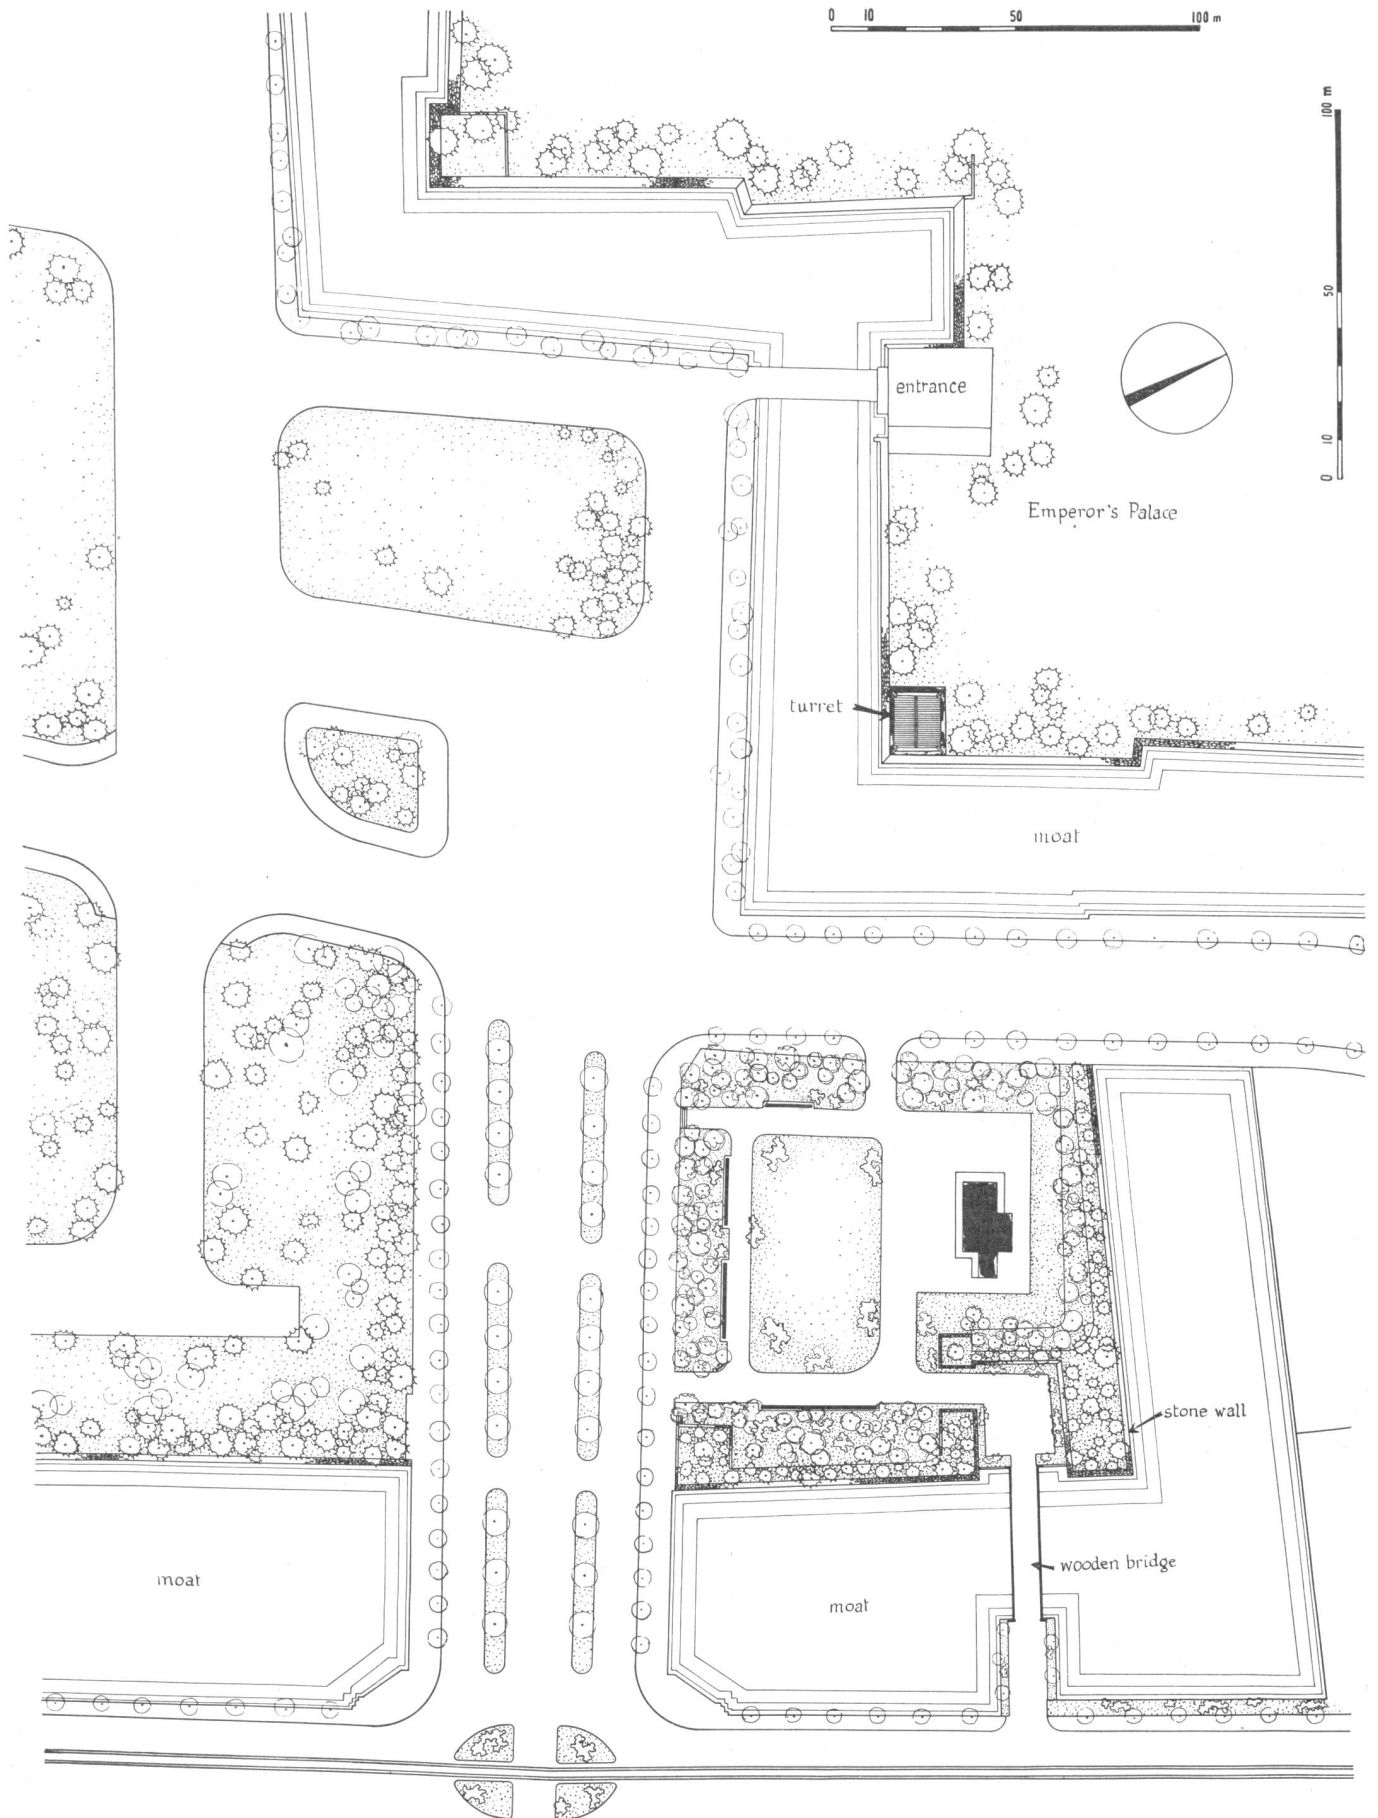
Plan des öffentlichen Parks vor dem Kaiserpalast in Tokio.
